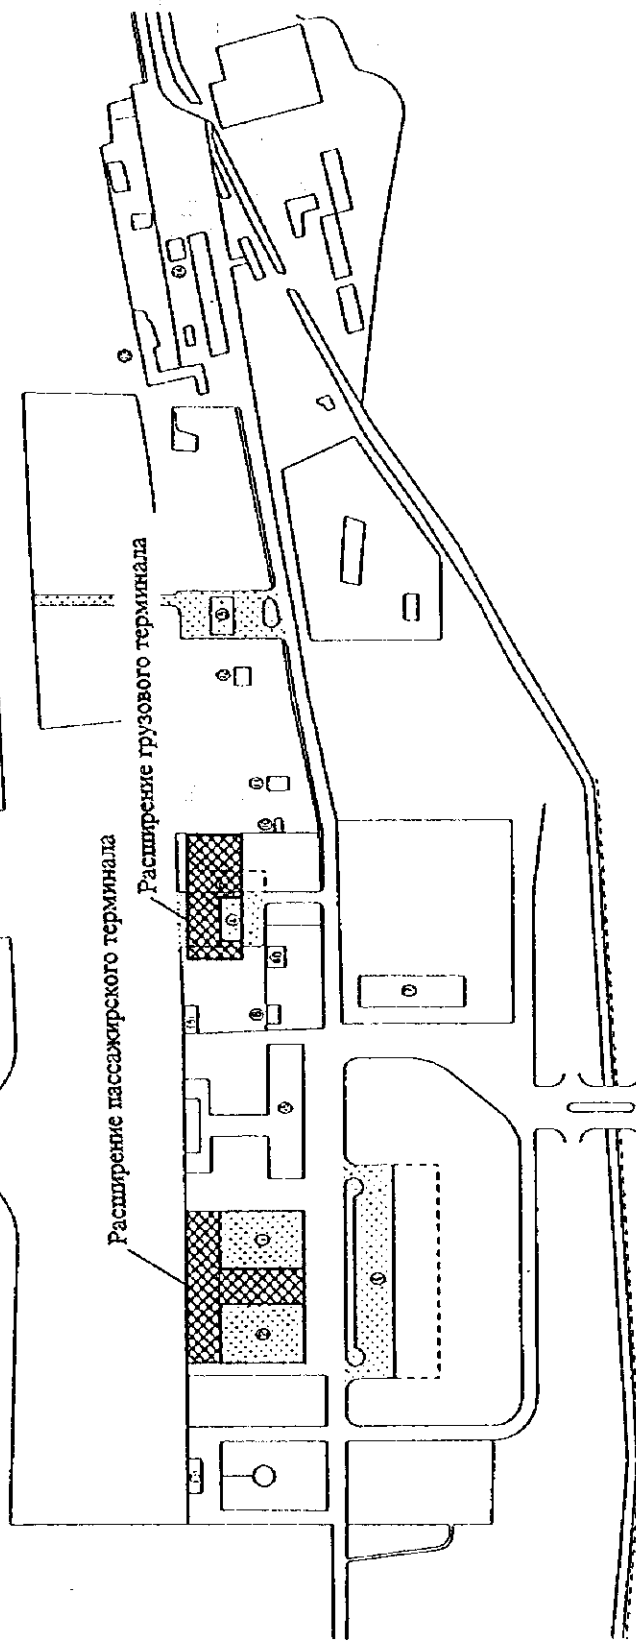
(1) План размещения аэровокзального комплекса аэропорта Ургенч
